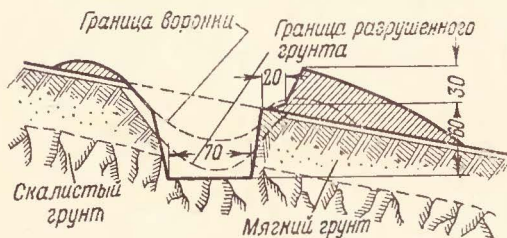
Профиль одиночного стрелкового окопа для стрельбы с колена, устроенный в воронке
